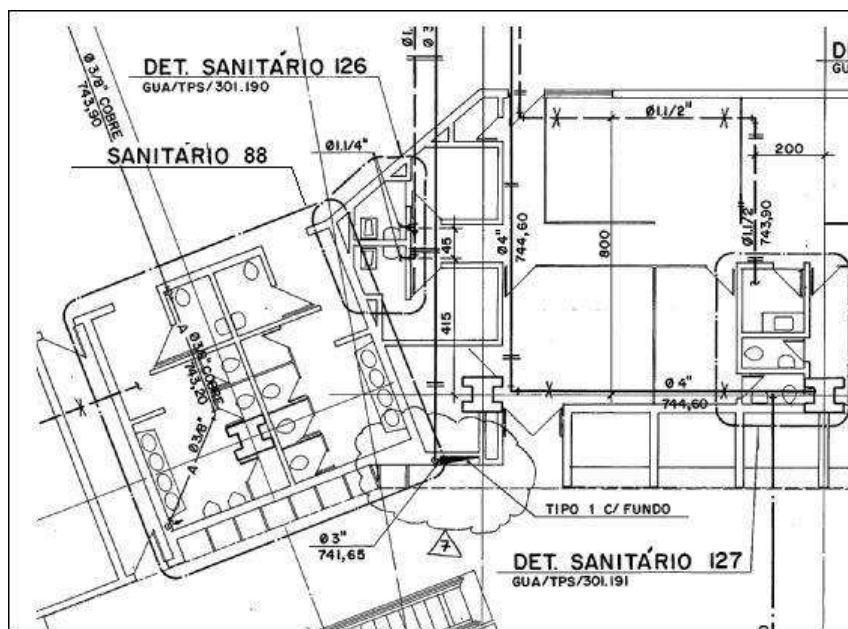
Imagem em planta de alguns sanitários existentes no pavimento inferior da ASA D do AISP.
